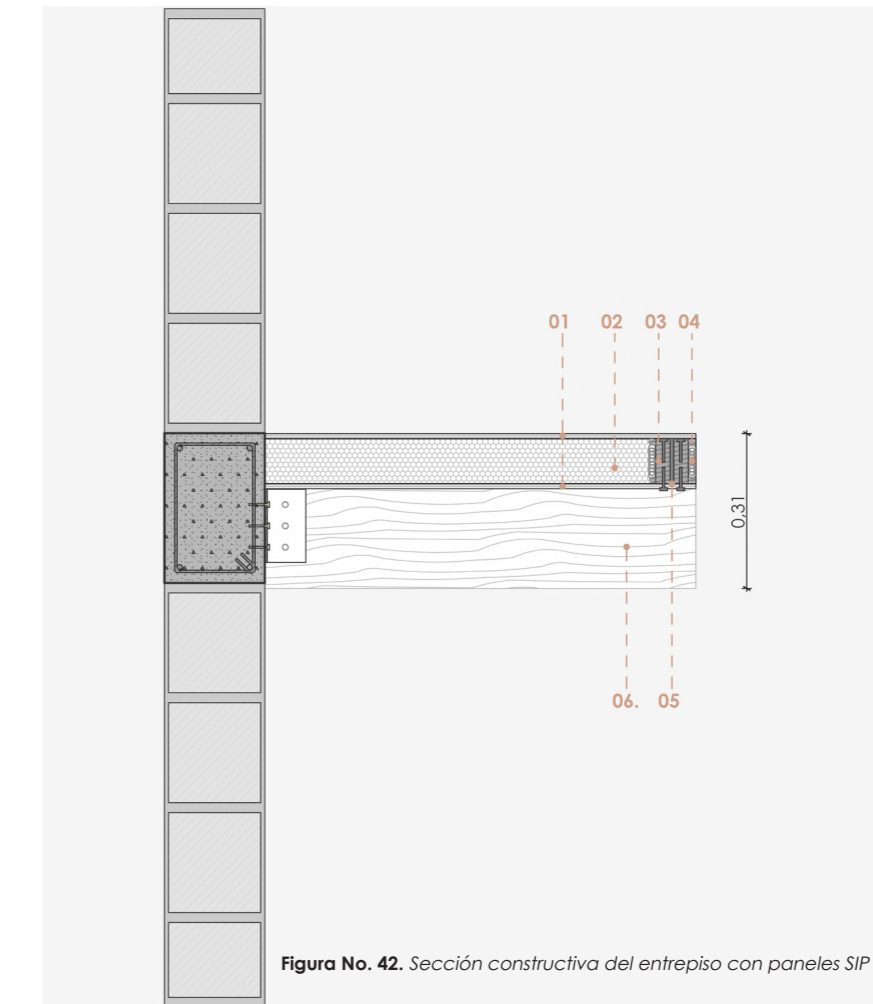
Sección constructiva del entrepiso con paneles SIP
